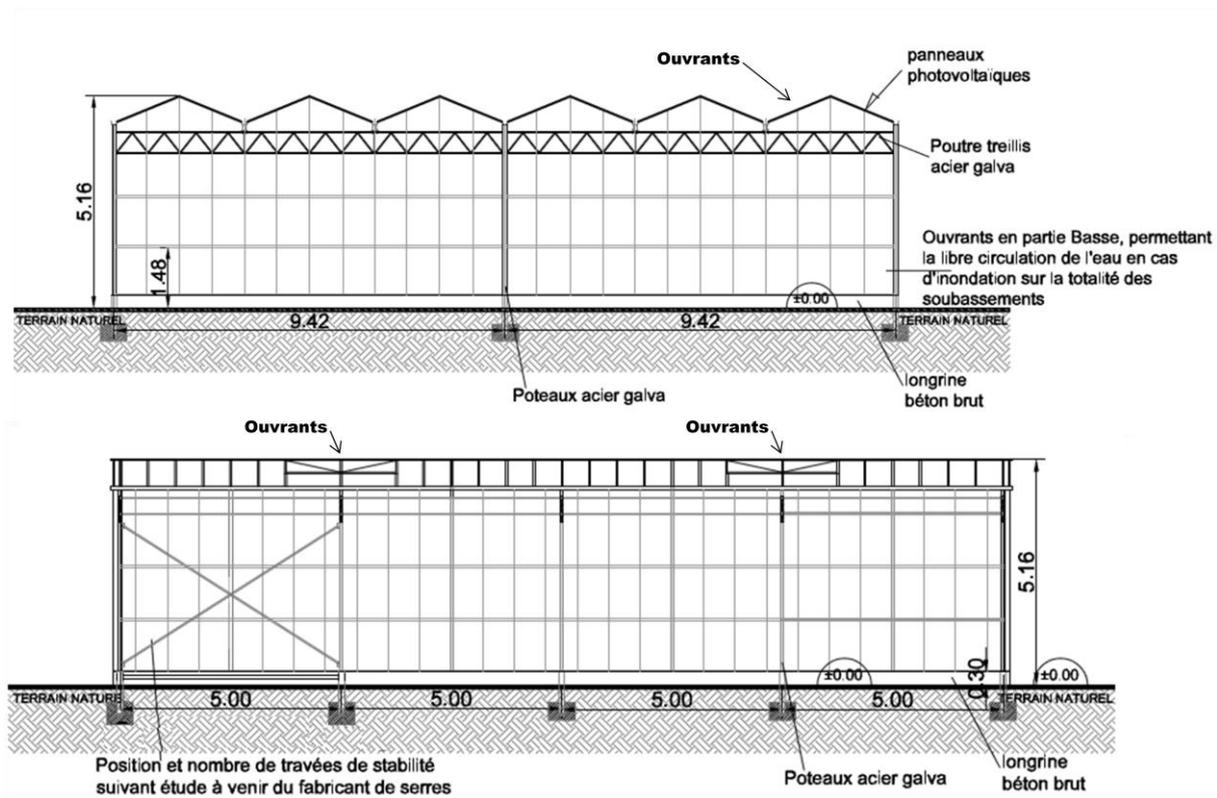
Plan d'une serre photovoltaïque type Venlo
